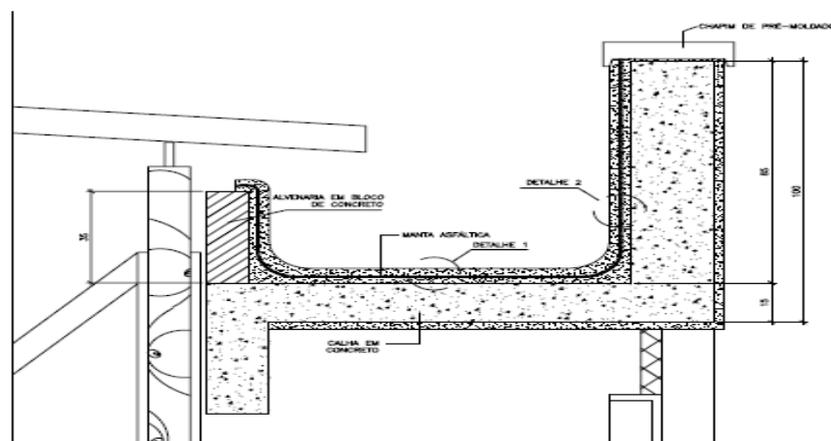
Detalhe da impermeabilização da calha, rufos e platibanda, a fim de evitar que haja infiltrações, rachaduras e dilatações superficiais
